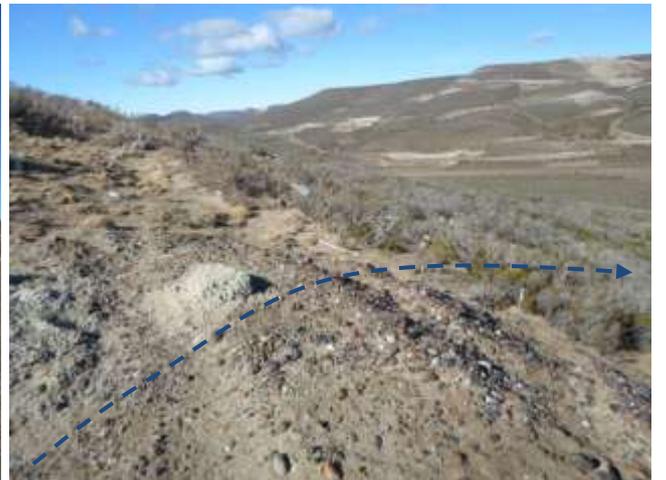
Emplazamiento de línea de inyección por margen interno de camino. Cruce con camino de acceso al Pozo G-242. Foto en dirección NO.
